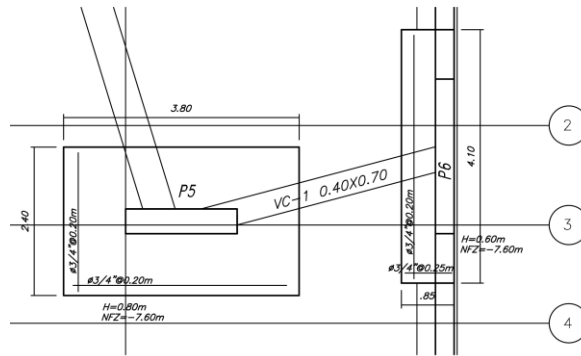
Vista en planta del diseño final de la zapata del ejemplo.
